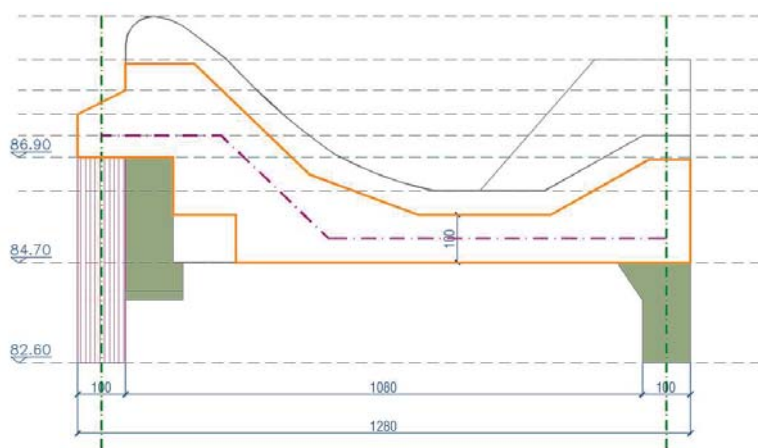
Planimetria delle diaframature di fondazione da progetto 1996 – Tavola 46
